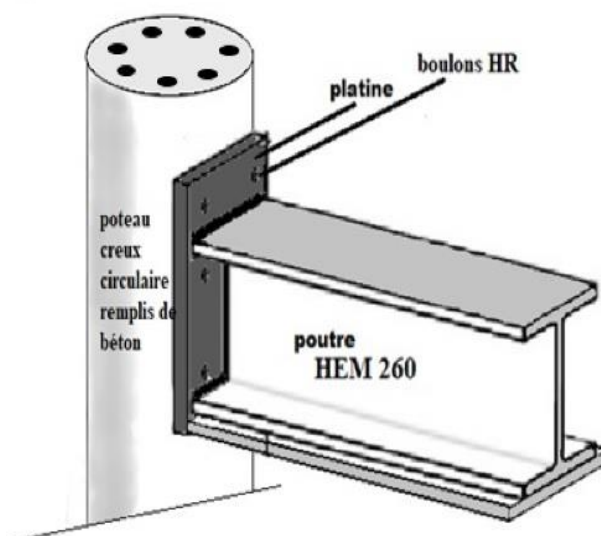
assemblage poteau poutre avec platine d'extrémité.
